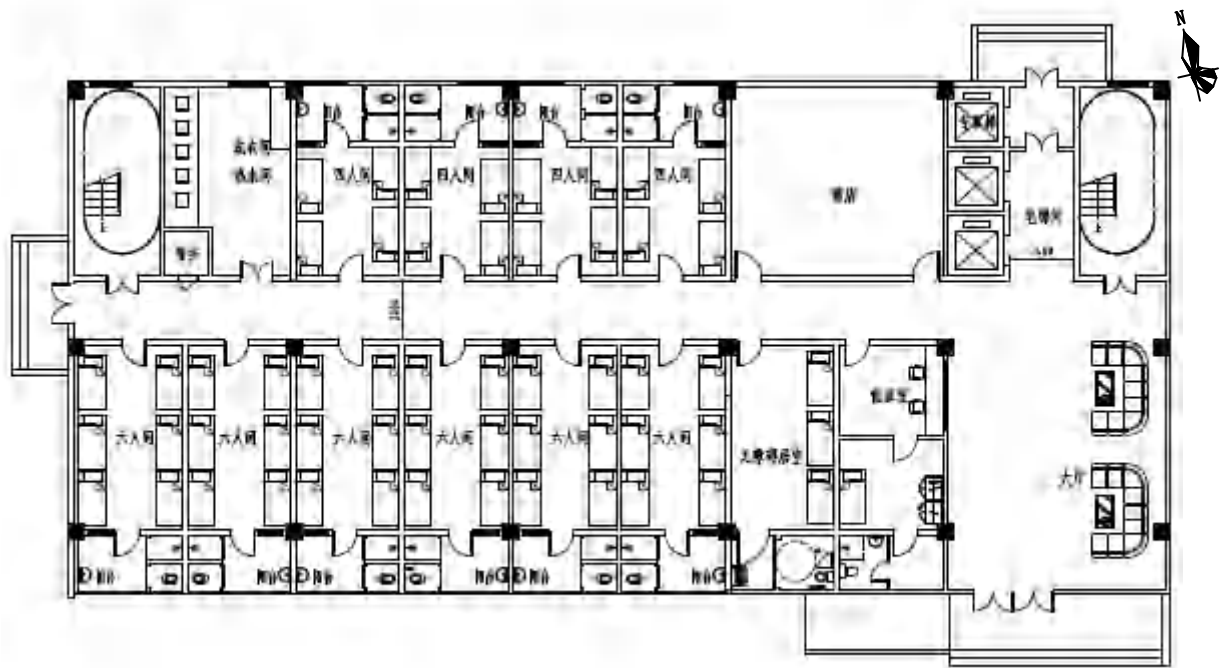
项目宿舍楼首层平面布置图（比例尺：1:297）
